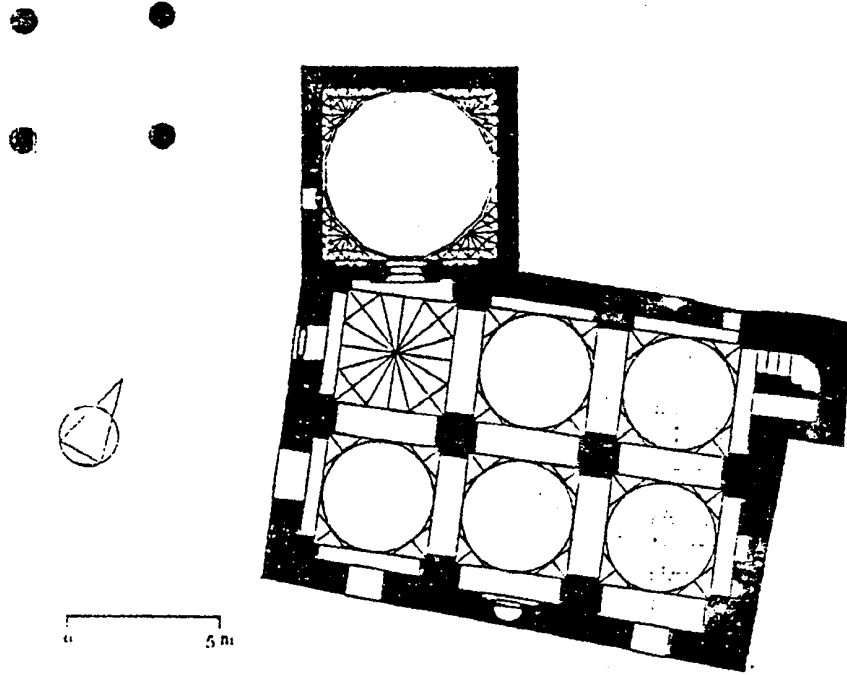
مسقط أفقي لمسجد تمور باليمن
